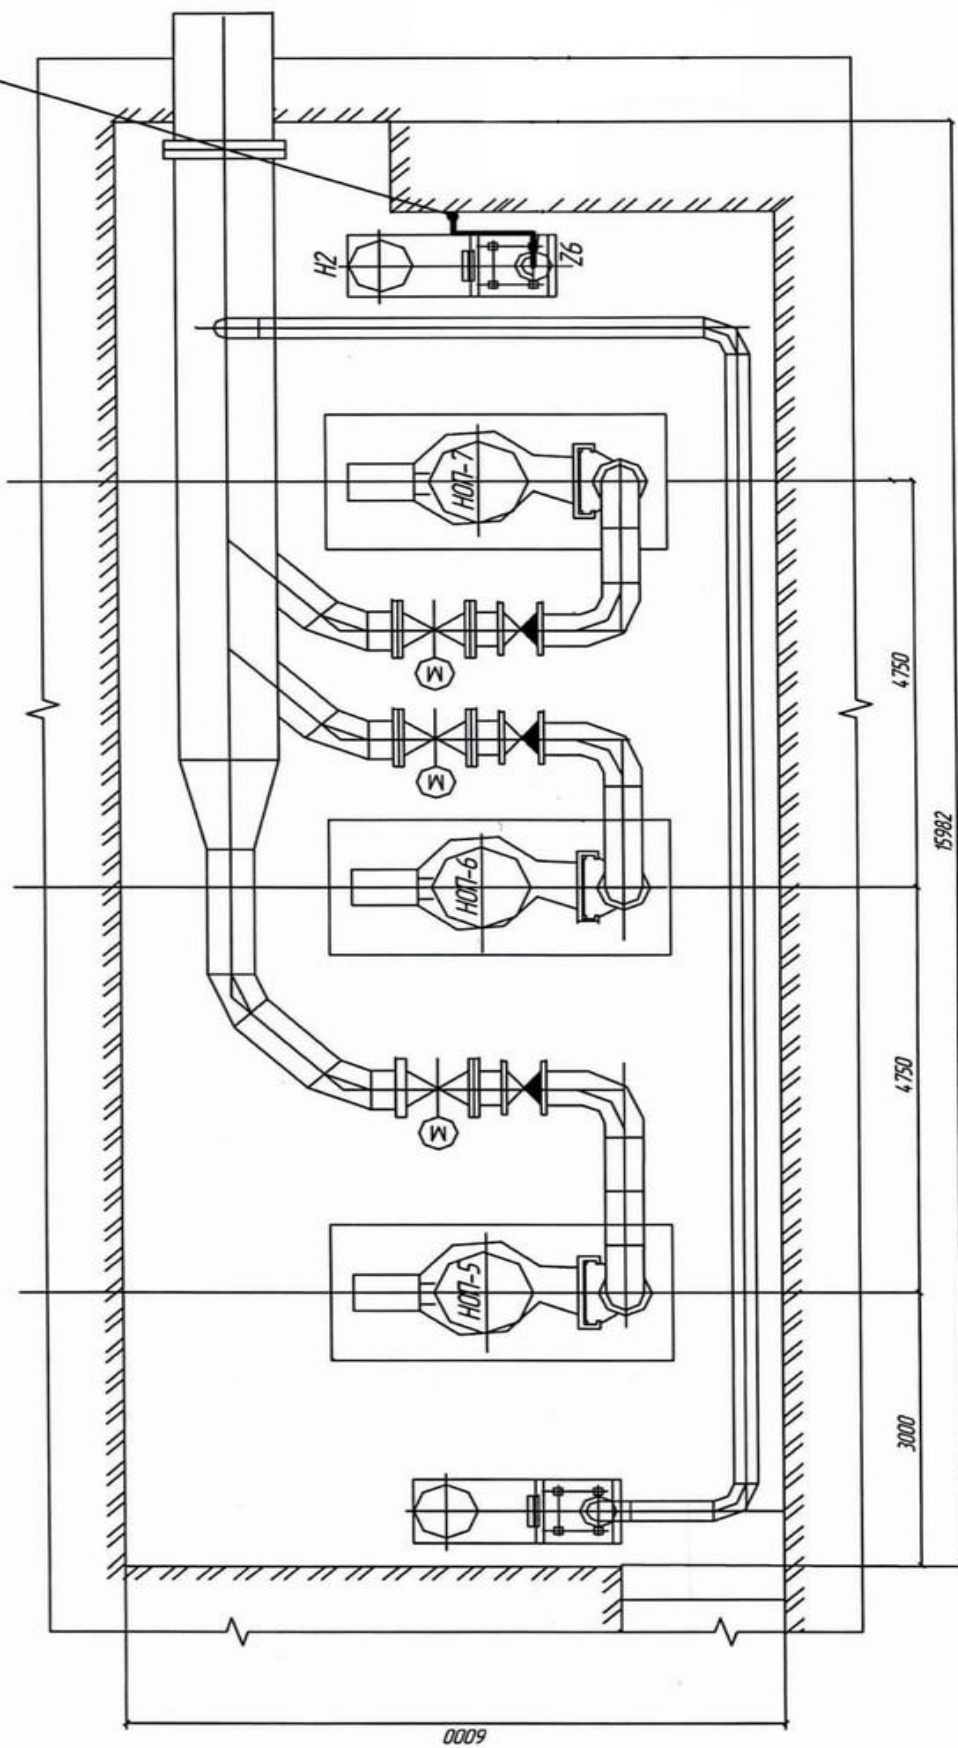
План расположения оборудования и проводок северной насосной станции
